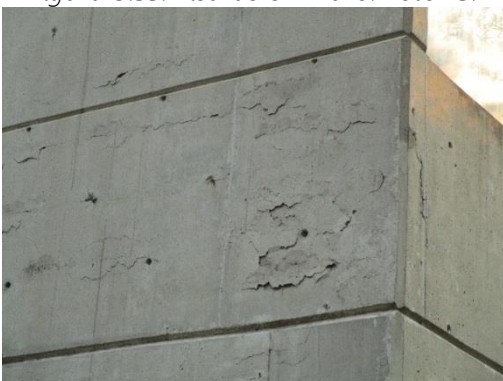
Fisuras en trabe. Foto 17.
